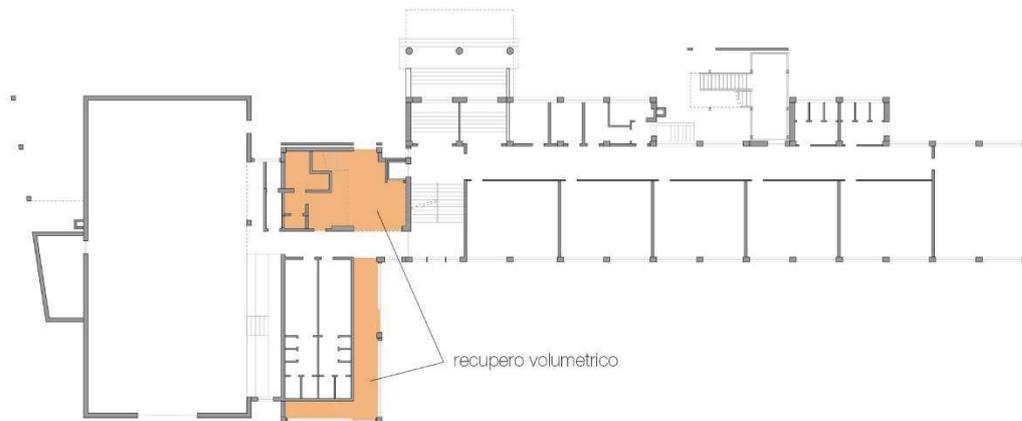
schematizzazione dell'intervento di recupero volumetrico al piano terra.
